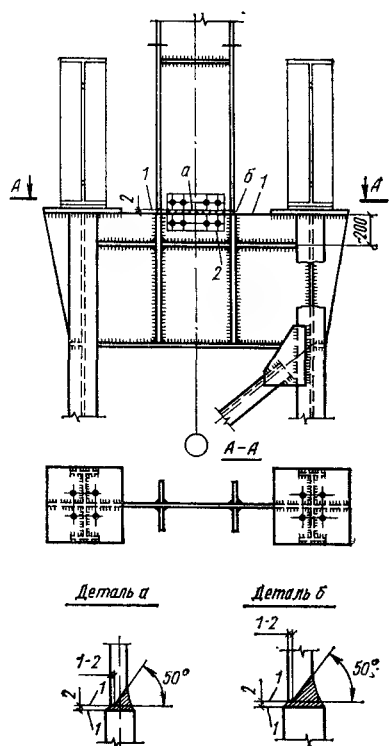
Соприжение надкрановой и подкрановой частей ступенчатой колонны среднего ряда
